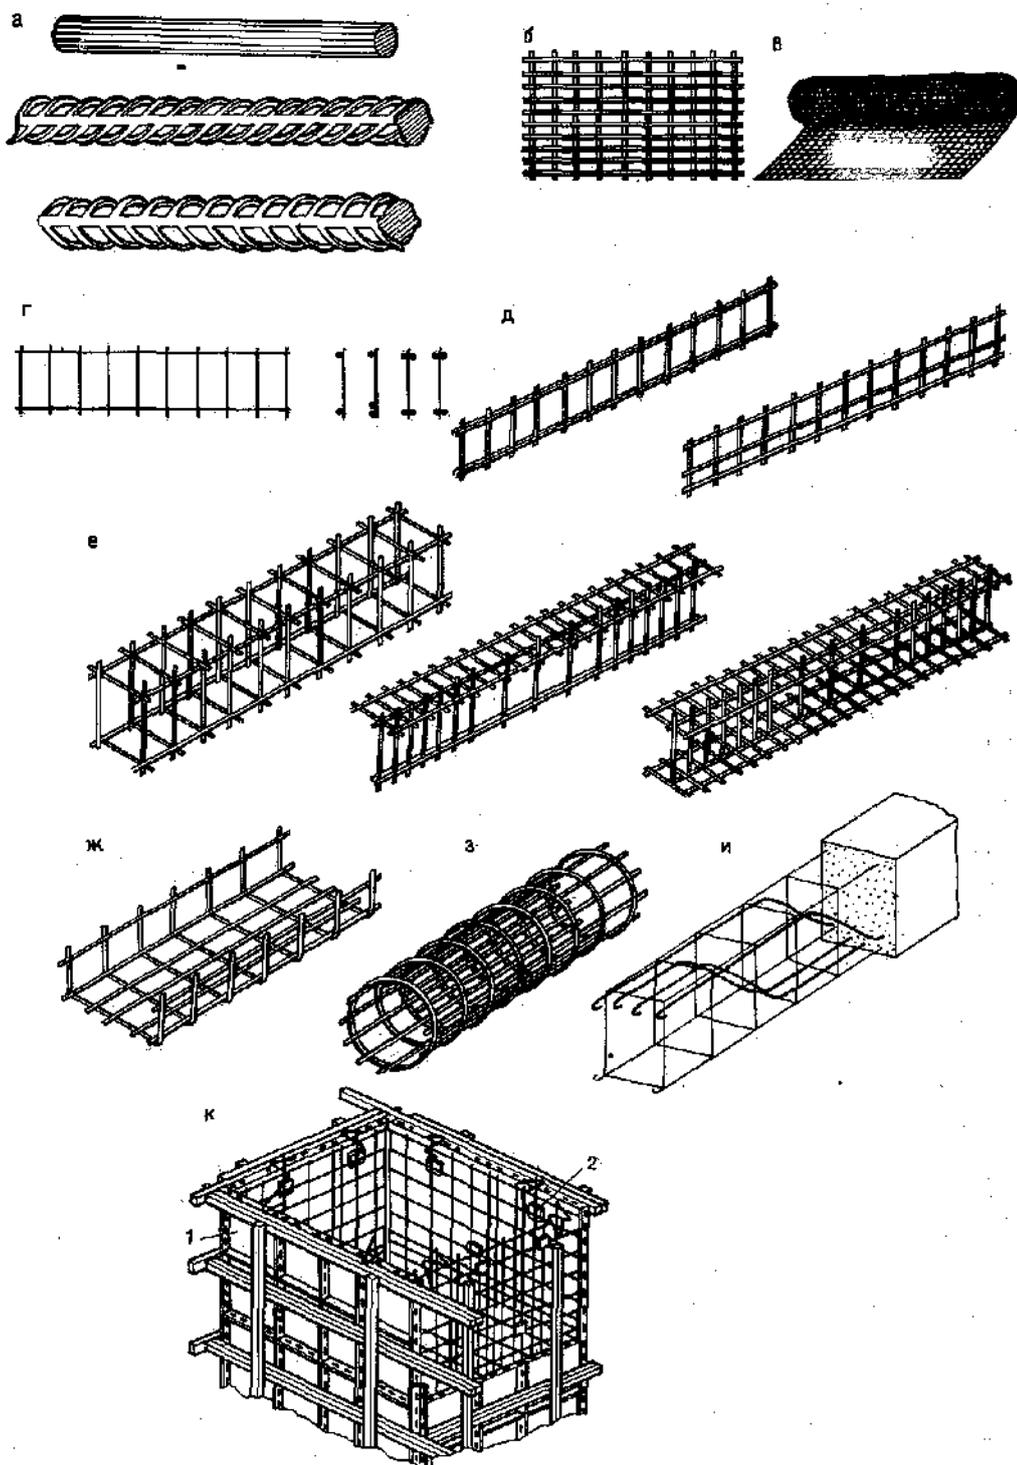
Виды арматуры : а – арматурные стержни; б – плоская арматурная сетка; в – рулонная арматурная сетка; г – проволочная арматура; д – плоские каркасы; е – пространственные каркасы; ж – гнутый каркас; з – цилиндрический каркас; и – каркас с отогнутыми стержнями, вязанный; к – арматурно-опалубочный блок; 1 – щит опалубки; 2 – арматурный каркас
